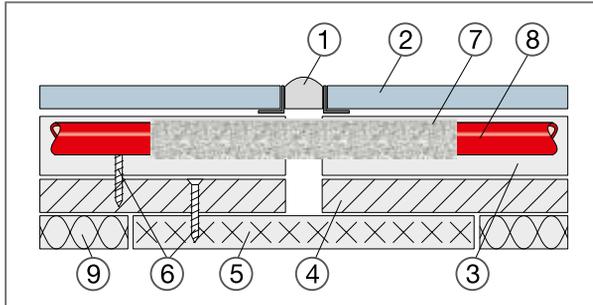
Schnitt Bodenaufbau auf Dämmung und Gipsfaser-Ausbauplatte
